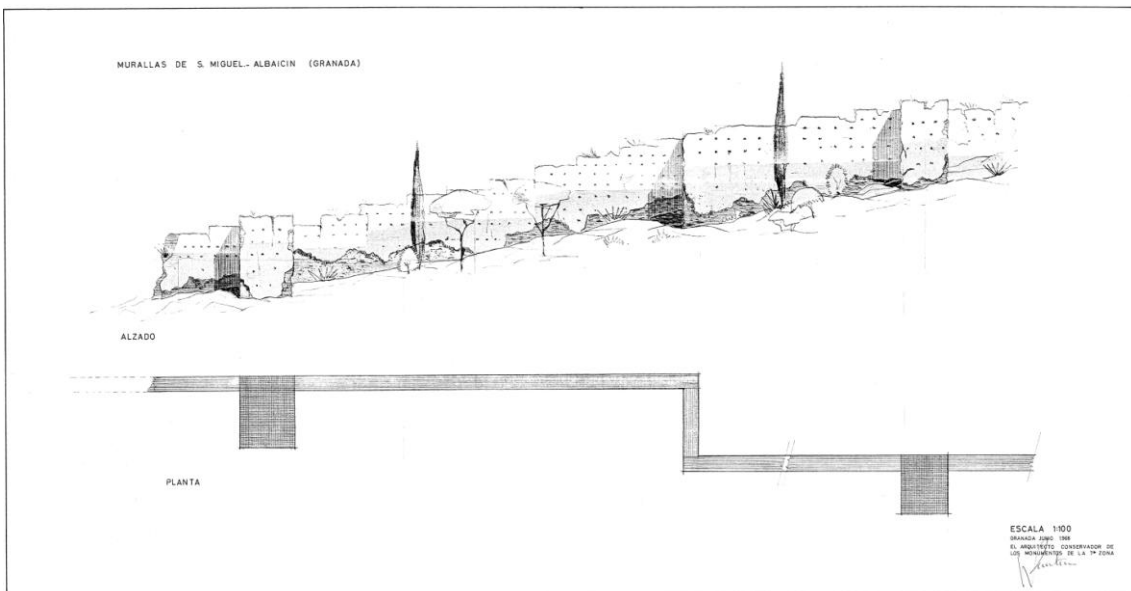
Prieto-Moreno. *Planos Muralla San Miguel* . Proyecto 1968
